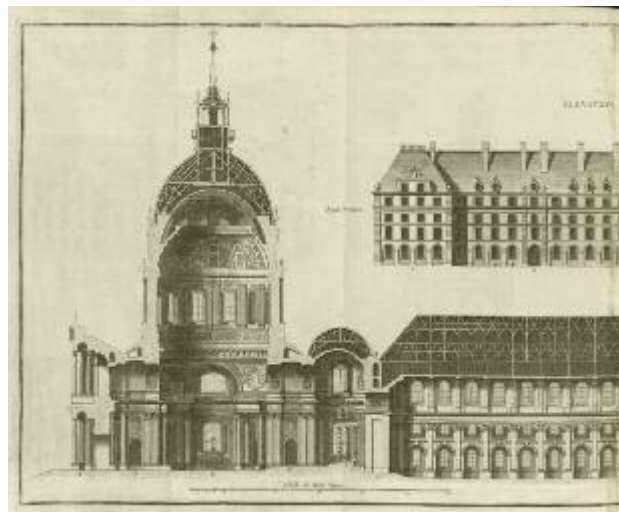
J.F.Blondel, Elevation de la principale entrée de l'hotel royal des Invalides du côté de la riviere (da J.F. BLONDEL, 1752, planche 7).
